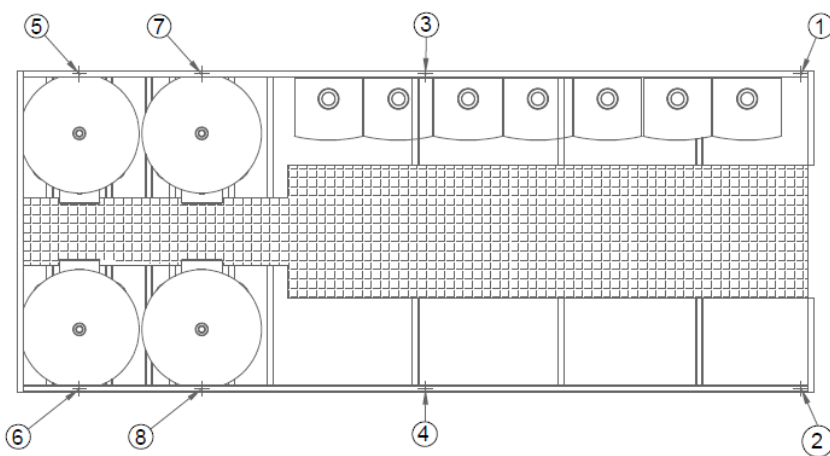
Planta Sala de Calderas Modular tipo C con espacios requeridos para instalación.
